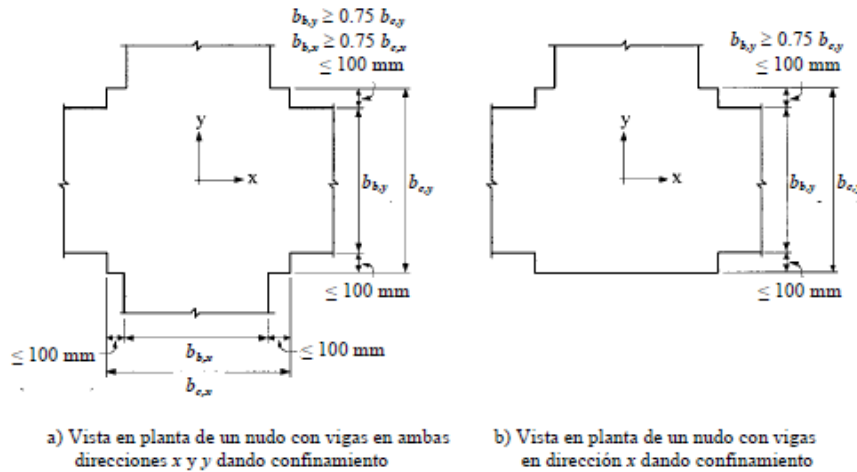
Requerimientos para una adecuada conexión viga – columna.
